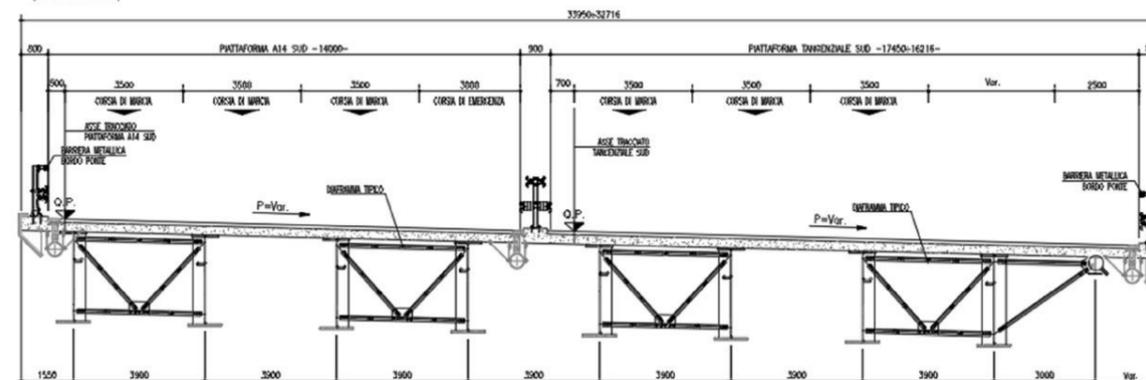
Sezione tipo di progetto ponte sul fiume Reno Via Sud e Via Nord¹⁸
